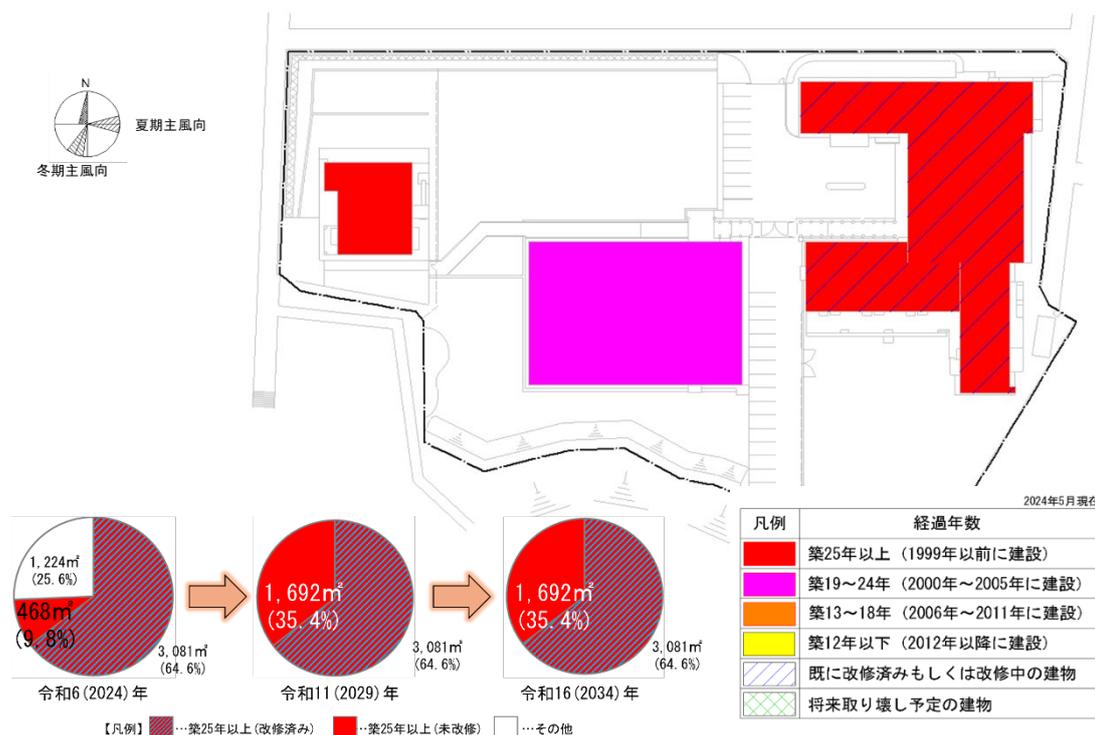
：東兼六地区の施設配置図（経年状況を含む）
